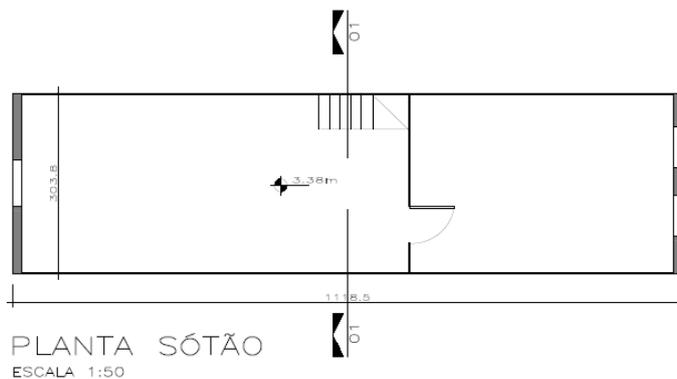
PLANTA BAIXA CASA MAJ CZAK.
